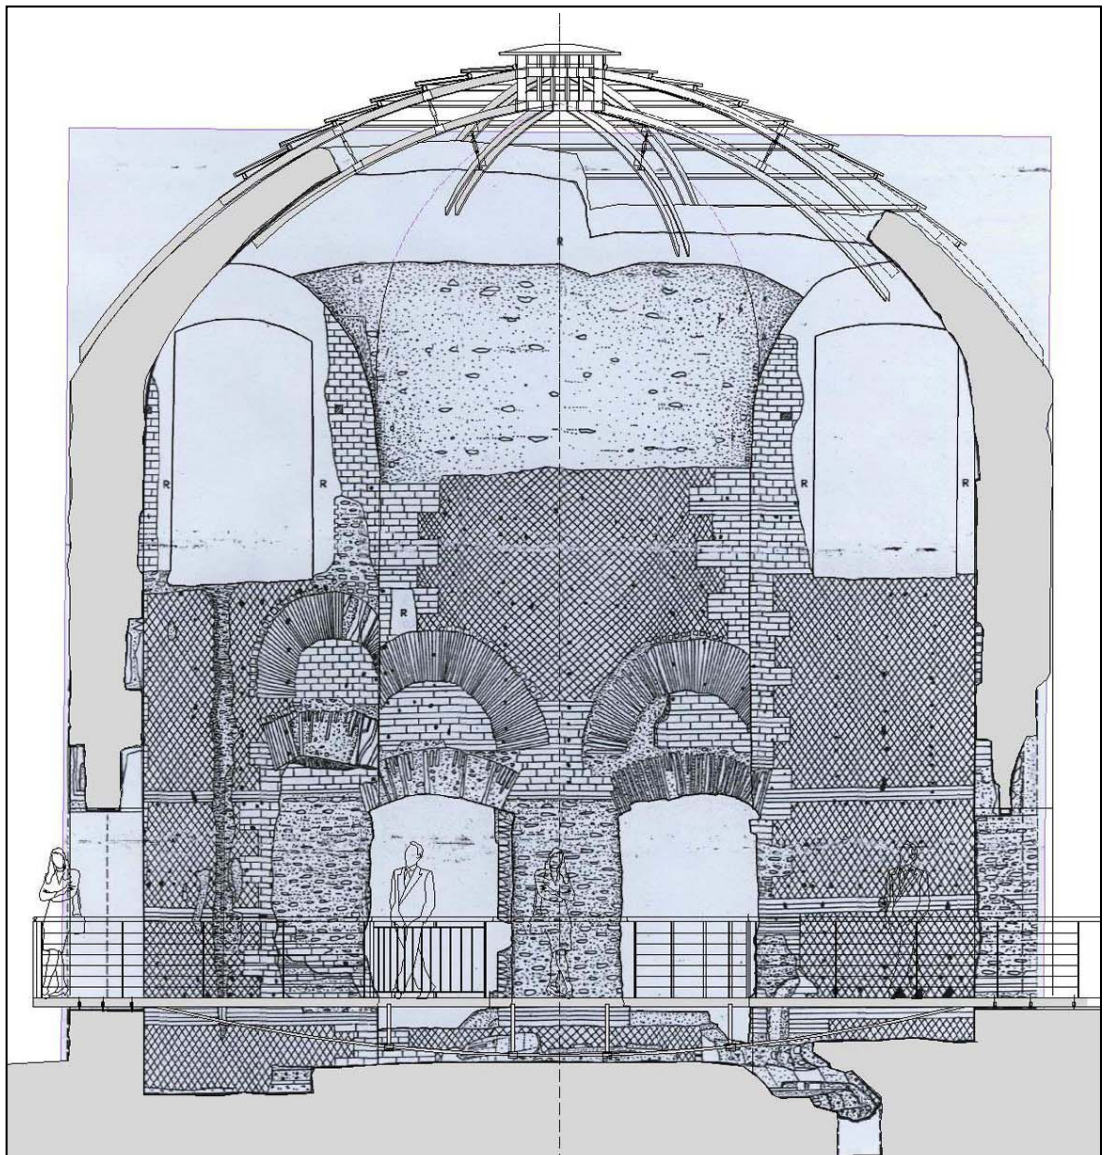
Sala Ottagona con l'inserimento della copertura filtrante e della passerella ponte con attraversamento centrale che si appoggia sulle testate delle murature perimetrali.
